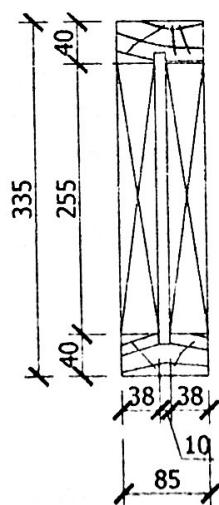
Соединение двутавровой деревянной балки на вклеенных стержнях:
